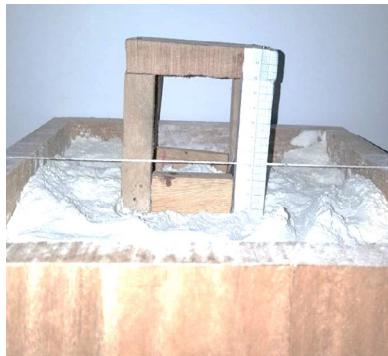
Detalle del montaje de la estructura simulada con columnas apoyadas sobre vigas de cimentación en suelo fino, sin carga adicional
